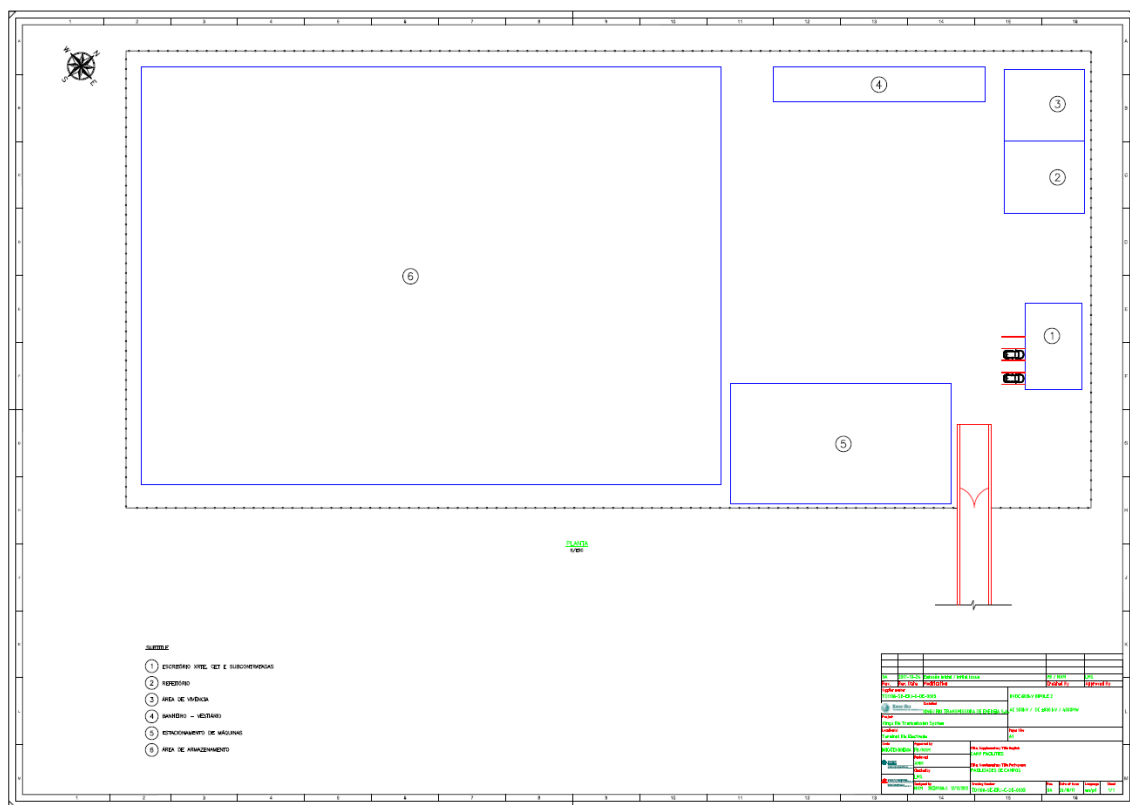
Layout Geral do Canteiro do Eletrodo.
